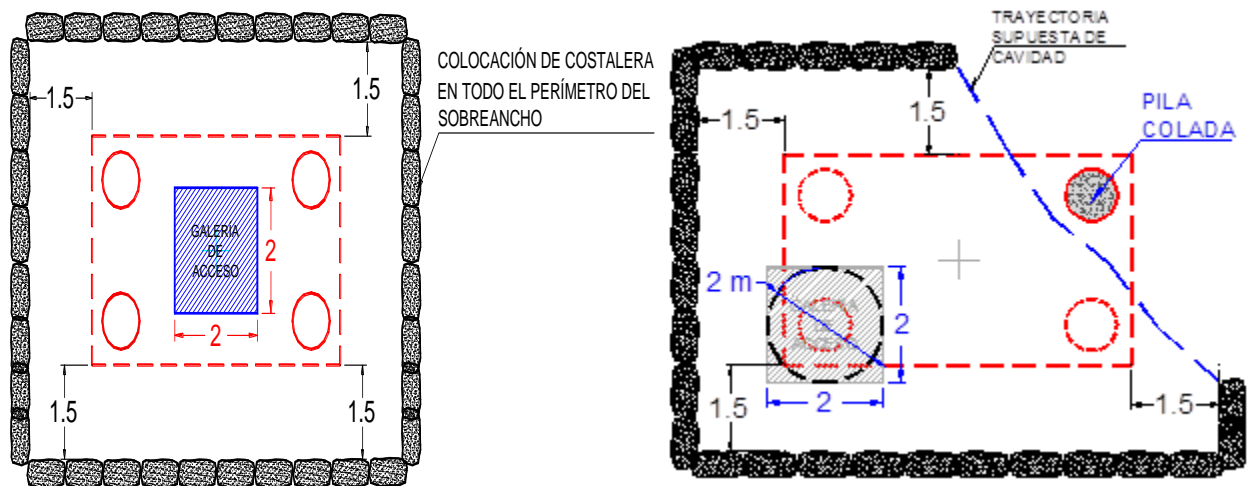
Colocación de confinamiento (Costalera). Pilas en Zona Minada
